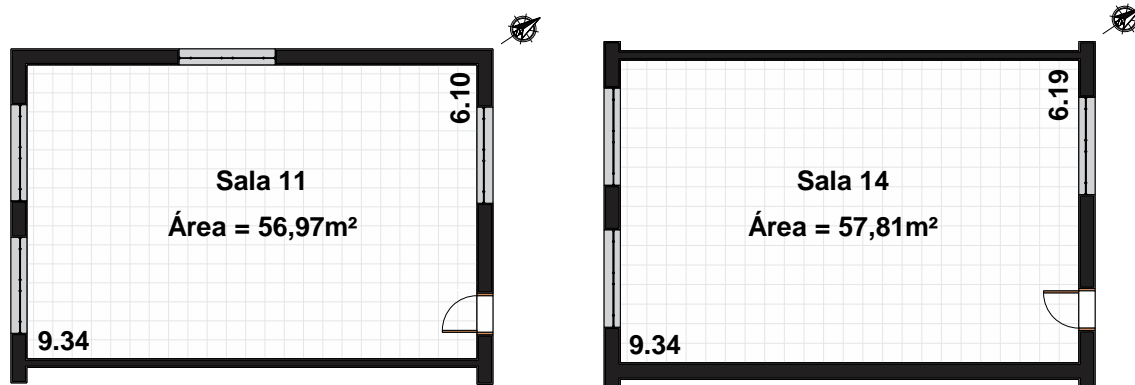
Plantas Baixas das salas 11 e 14, respectivamente.
